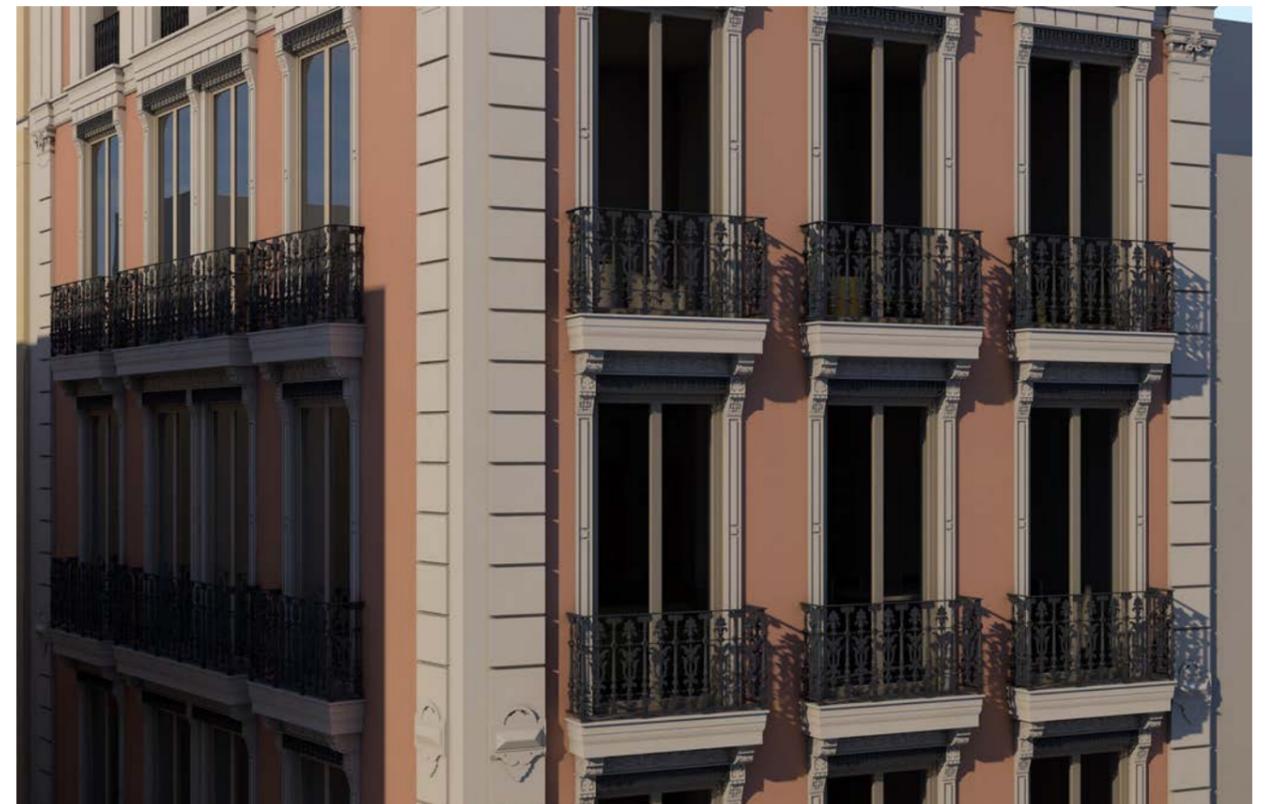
Perspectiva detalle plantas segunda-tercera-cuarta.
